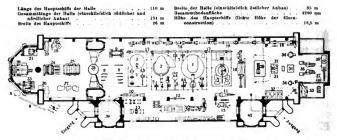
Lageplan der Ausstellungsgegenstände in der Krupp Halle.
